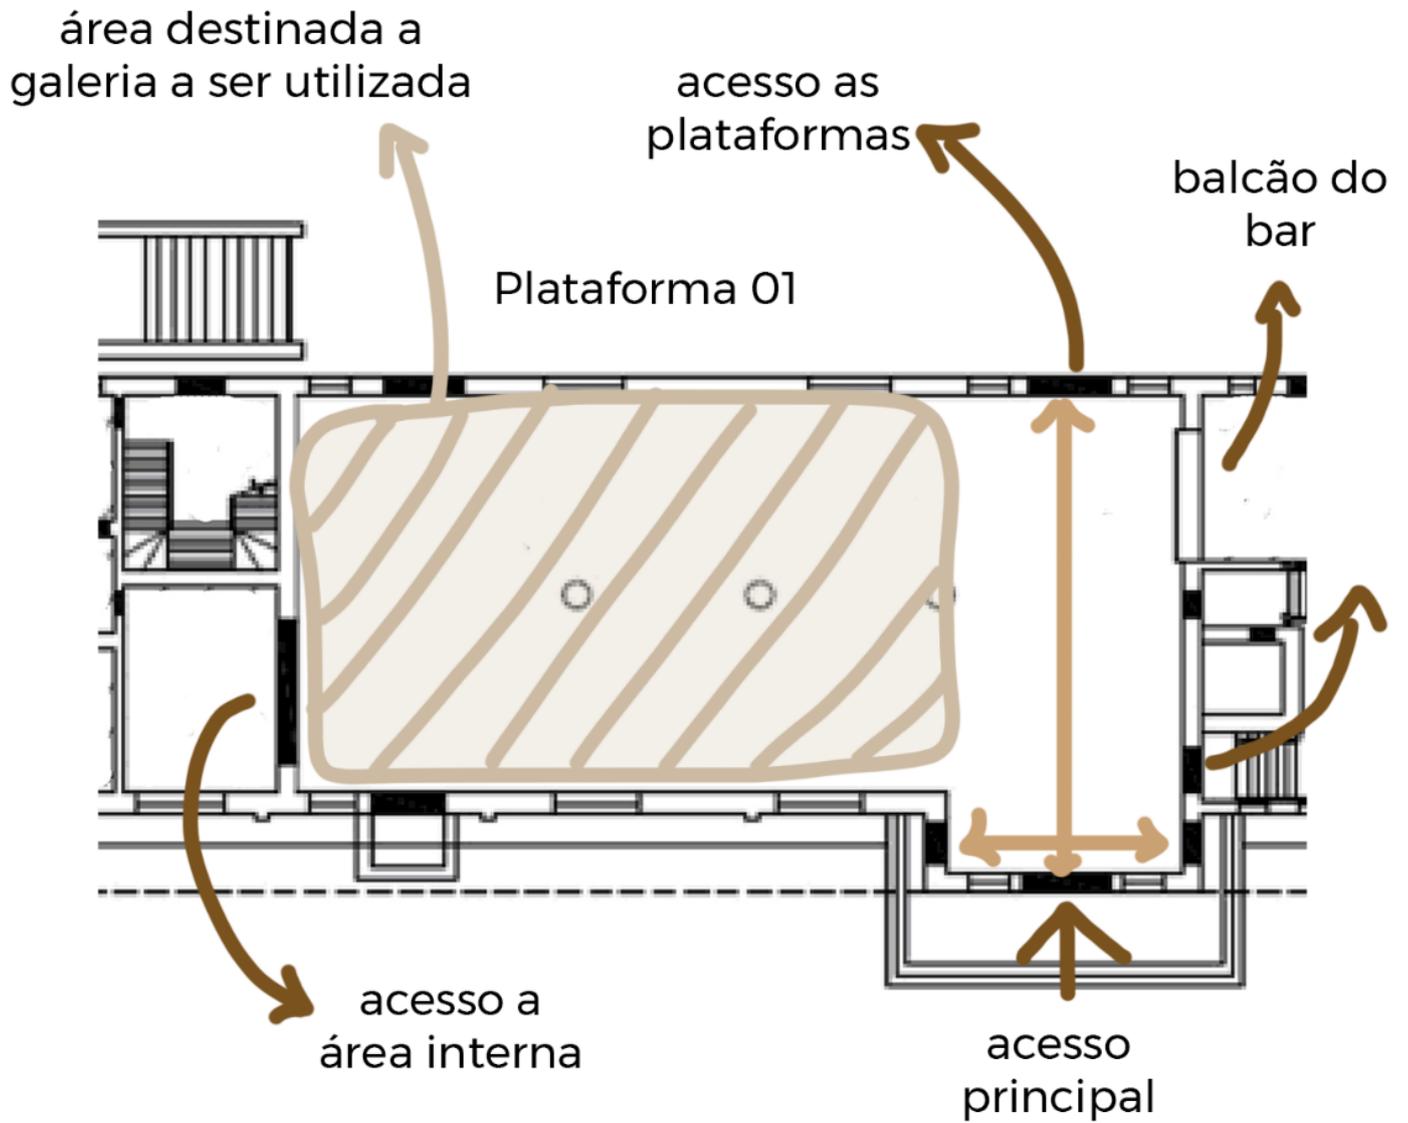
Planta da galeria da estação Cultura. Fonte: Esquema elaborado pela autora.
